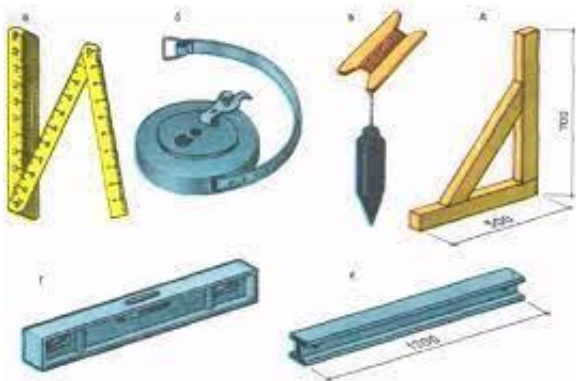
а).Контрольно- вимірювальні інструменти (традиційні): а - метр складний; б - рулетка; в - висок; д - кутник; е - будівельний рівень; ж - рейка-правило
